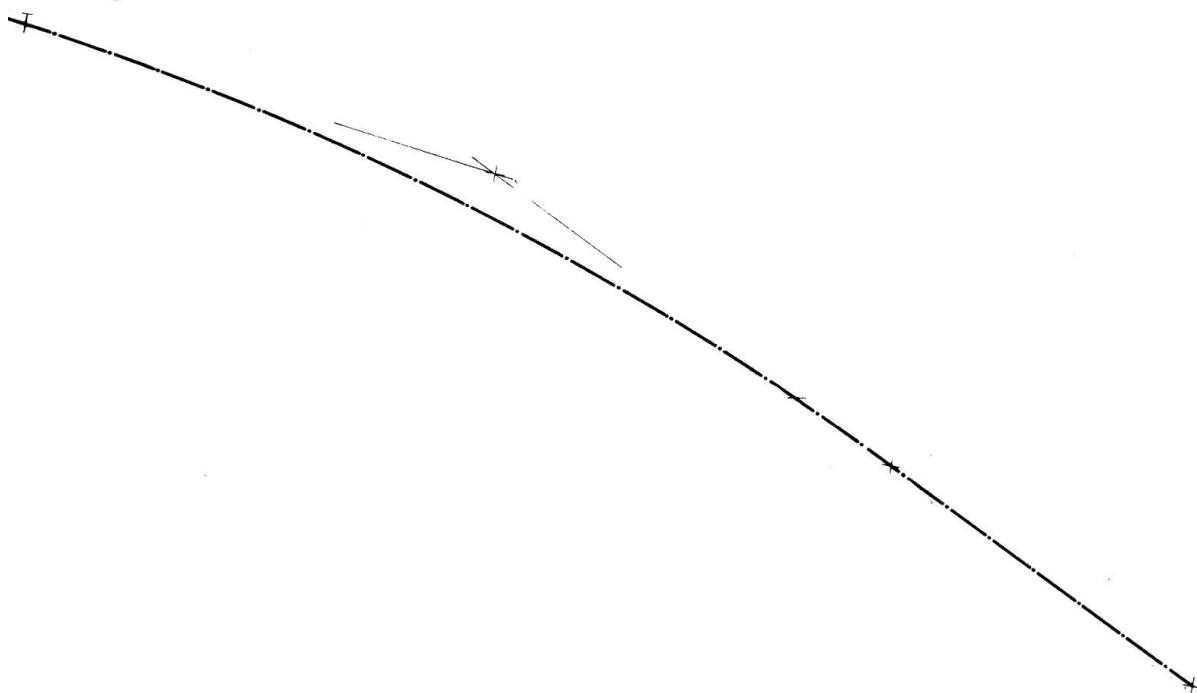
Traçado em planta de uma secção da linha A que inclui o troço 1
